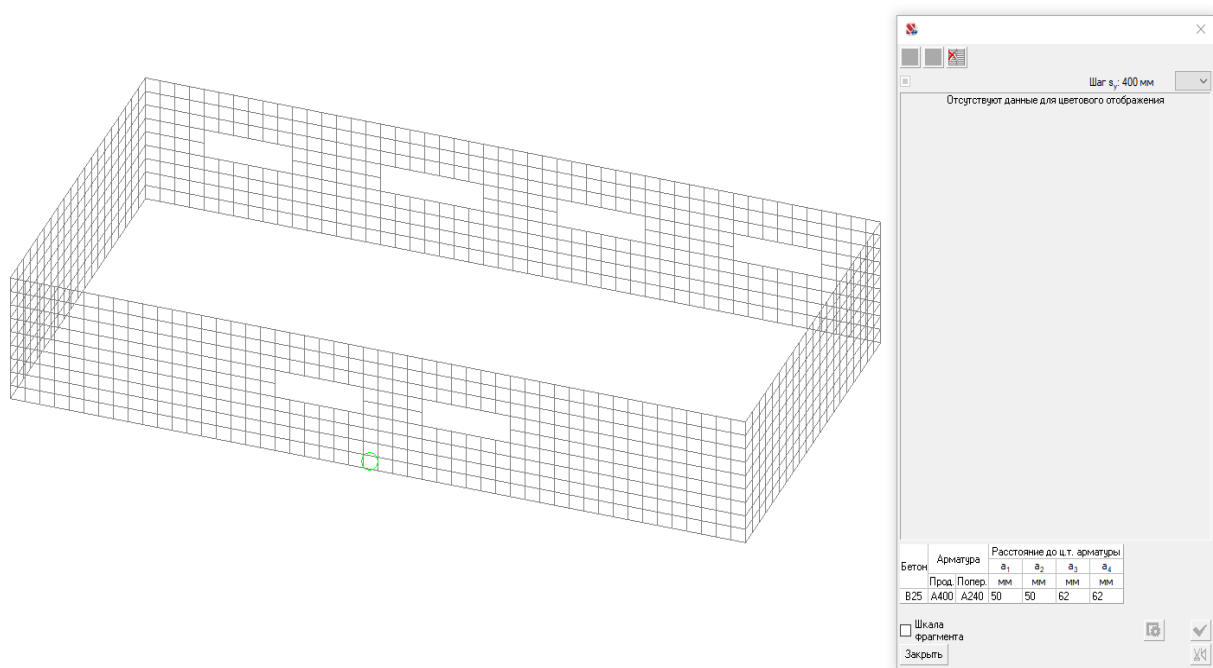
Армирование стен подвала поперечными стержнями
